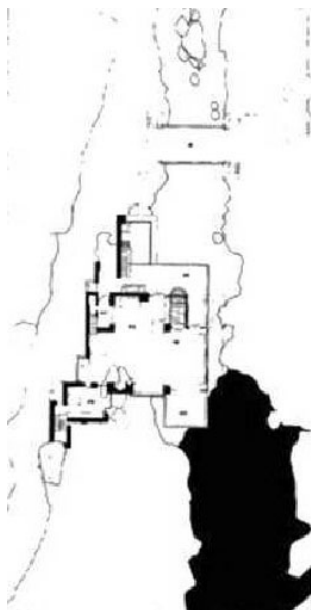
Casa Kaufmann – Bear Run – *Fallingwater* - planta baixa -1936
